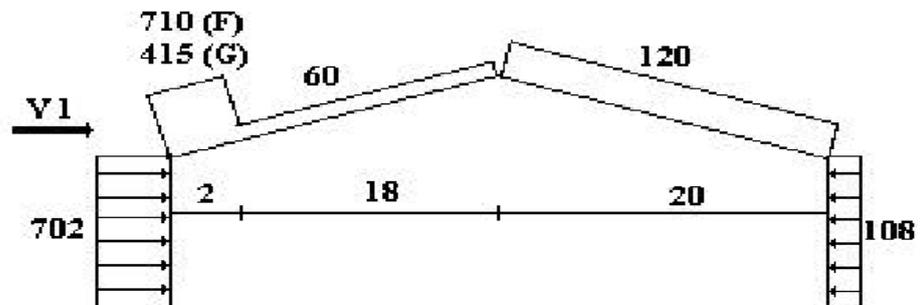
Répartition des pressions sur la toiture - Direction du vent V1
